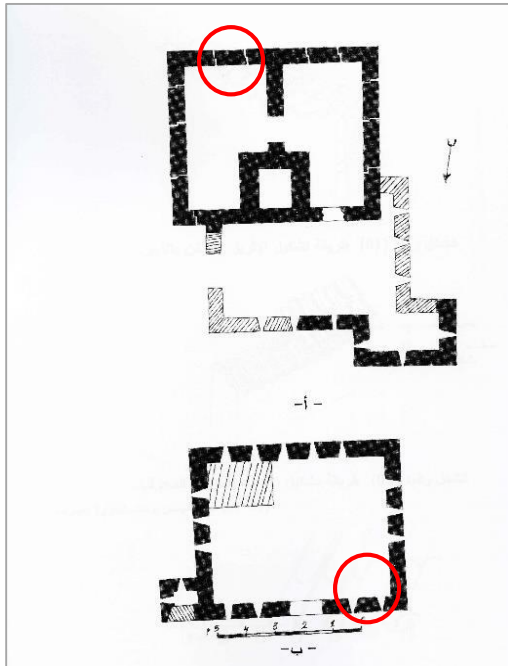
Plan rez de chaussée et 1<sup>er</sup> étage
